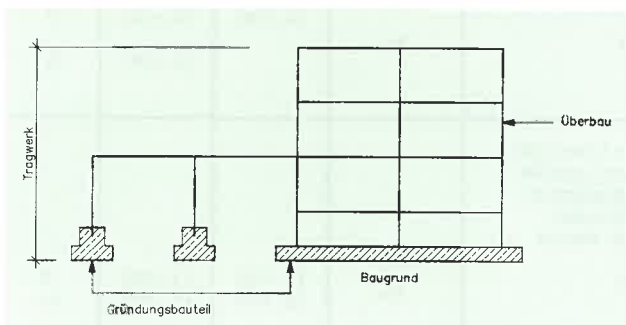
Definition Tragwerk, Gründungsbauteil, Überbau, Baugrund
